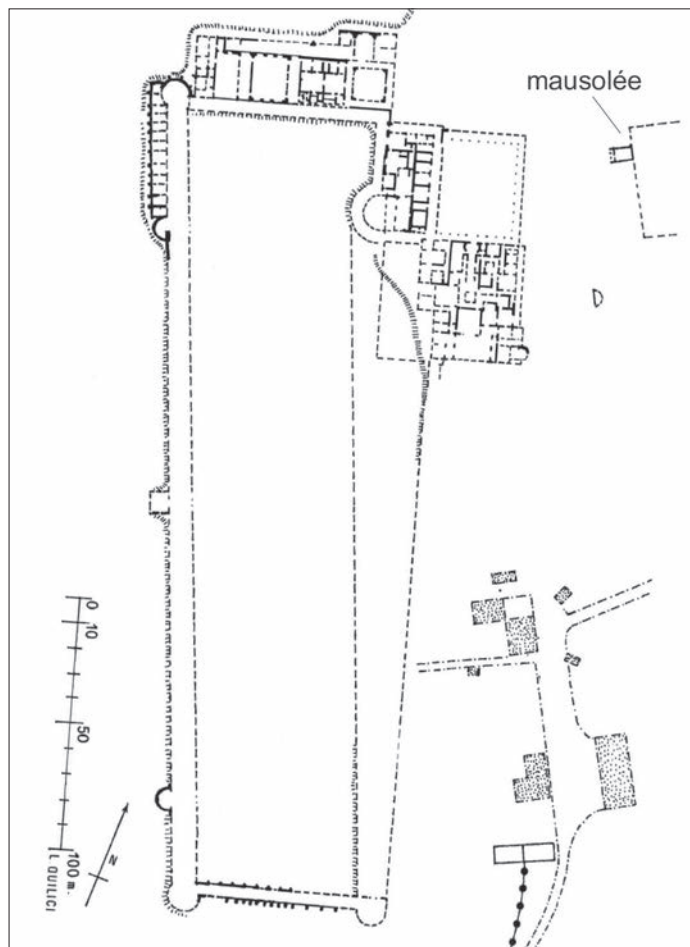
Plan de la villa de Sette Bassi (Rome) (Griesbach 2007).
